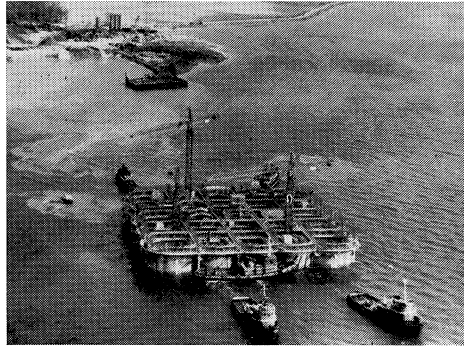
Das Verschleppen aus der Baugrube zum Ort wo der Betonkonstruktion vollendet wird.
